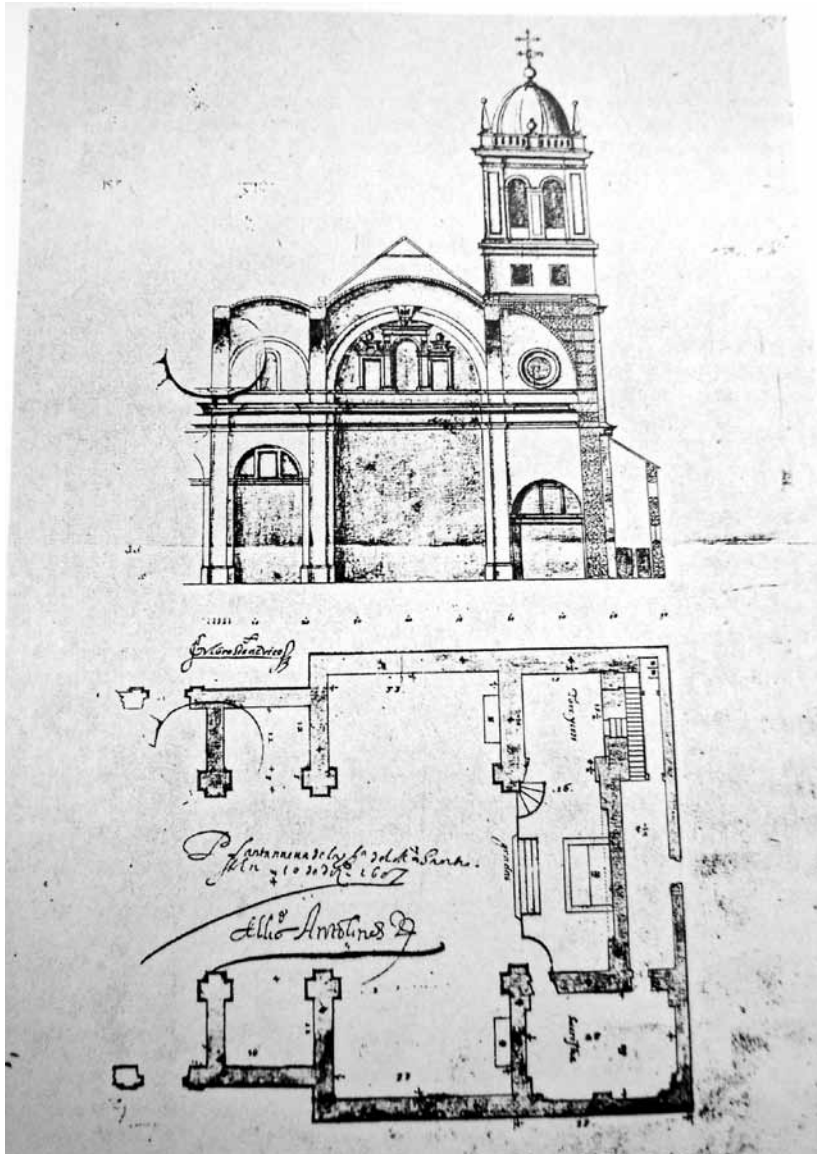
Ambrosio de Vico (1607). Alzado y planta de la iglesia de Santa María de la Alhambra.
